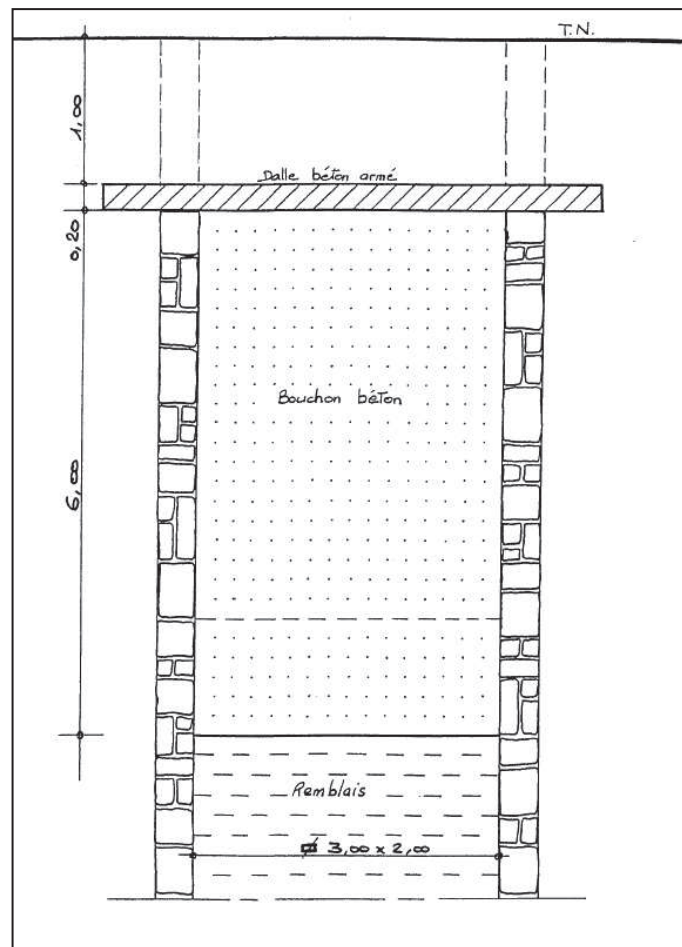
Schéma de mise en place du bouchon béton au puits de Tinderelle
